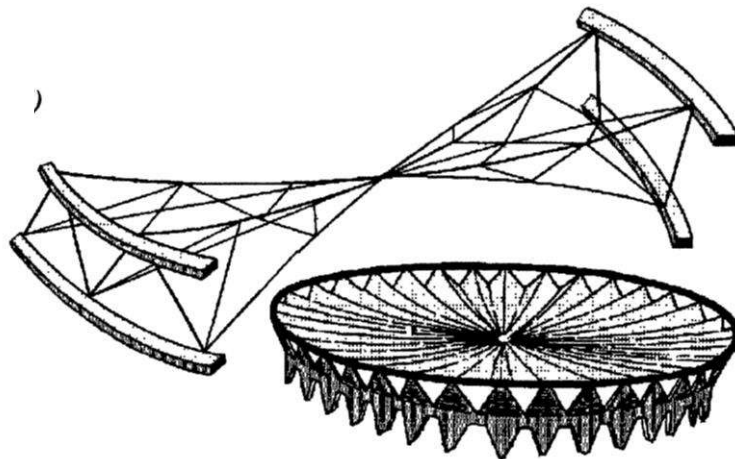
Тросовая ферма в круглых в плане зданиях.
